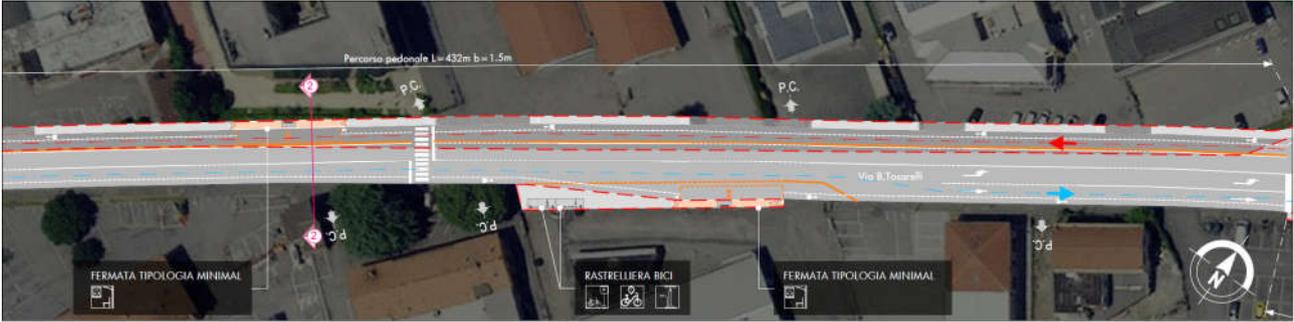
Fermata Ca dell'Orbo. Planimetria.
